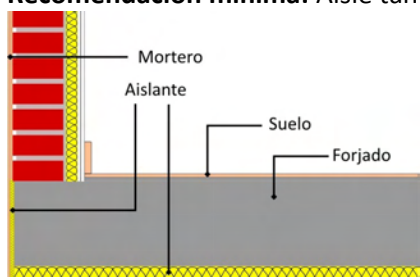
PT encuentro suelo-fachada. Trasdosado aislante interior
